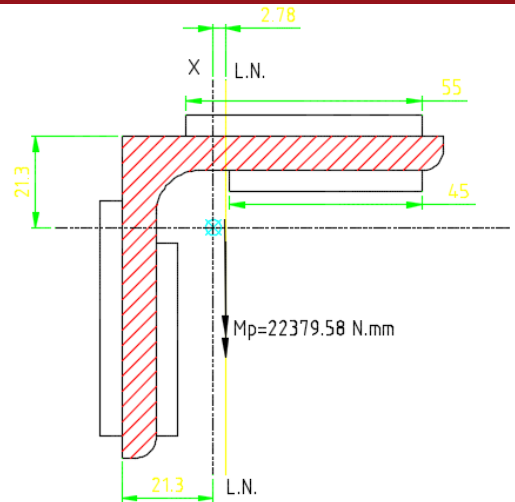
Geometría del cordón de soldadura en el perfil L
